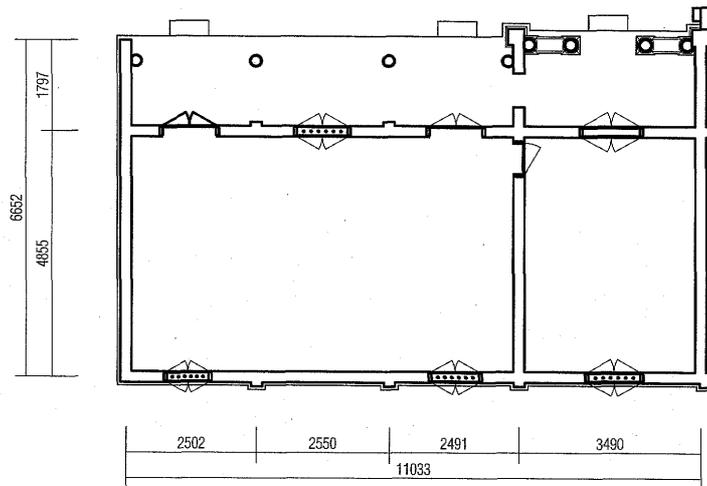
Nguyen Van Vung邸 主屋 平面图 1:150
